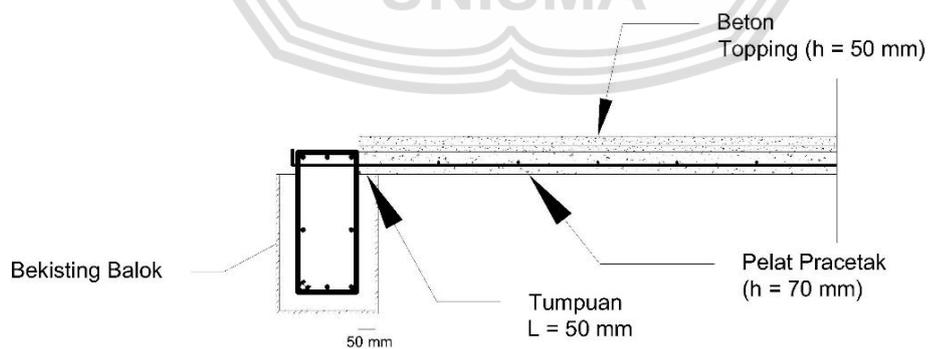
Sambungan Plat Pracetak dengan Balok Konvensional
